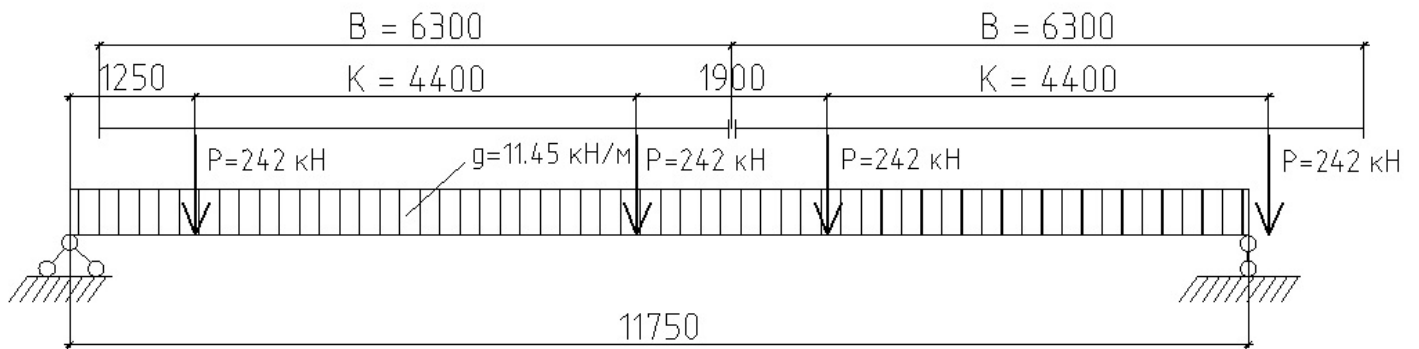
Розрахункова схема підкранової балки  $L=12$  м
